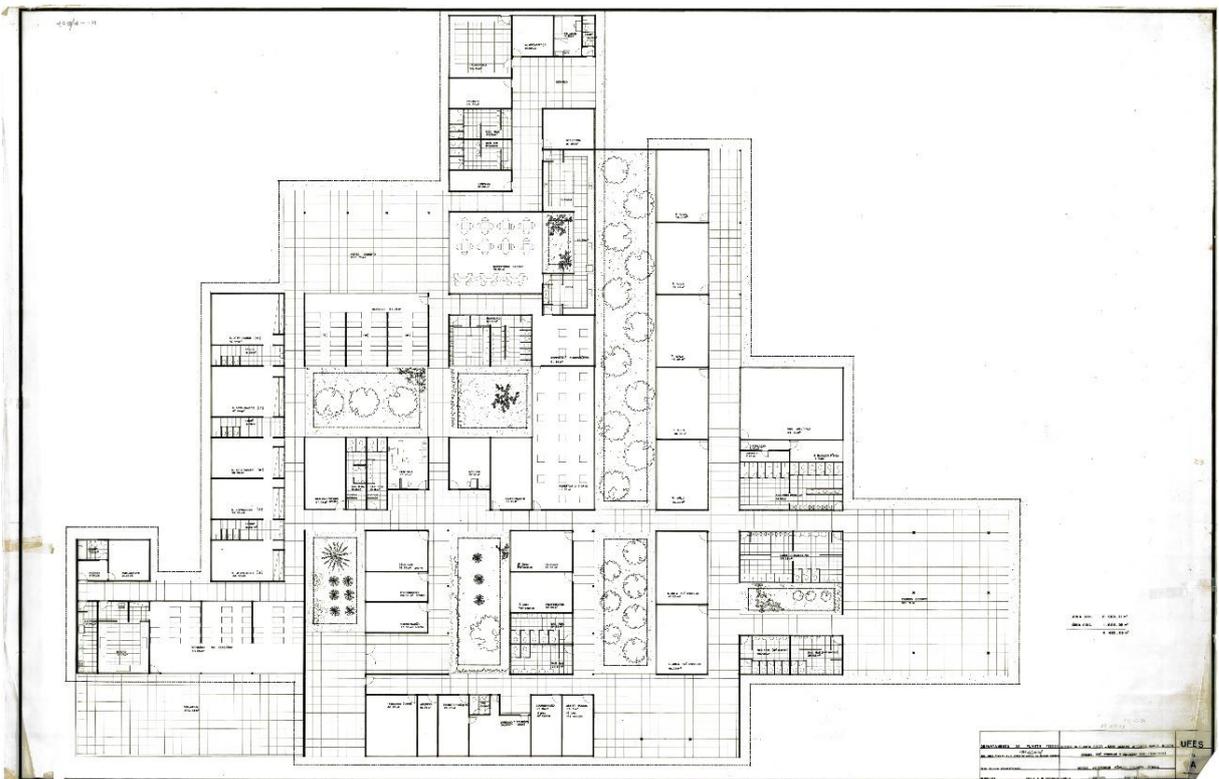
Planta-baixa bloco creche, pré-escolar e primeiro grau, proposta de março de 1982.
